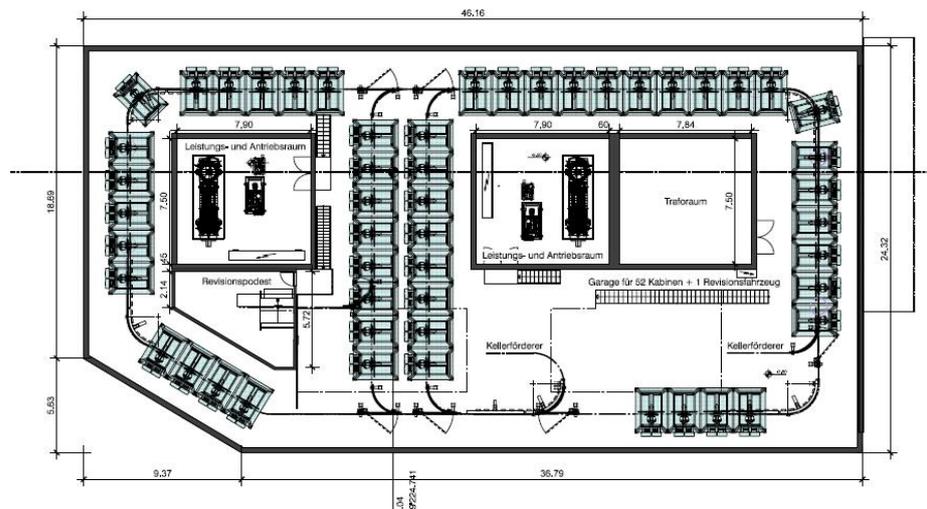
Beispiel Grundriss einer Kellergaragierung
